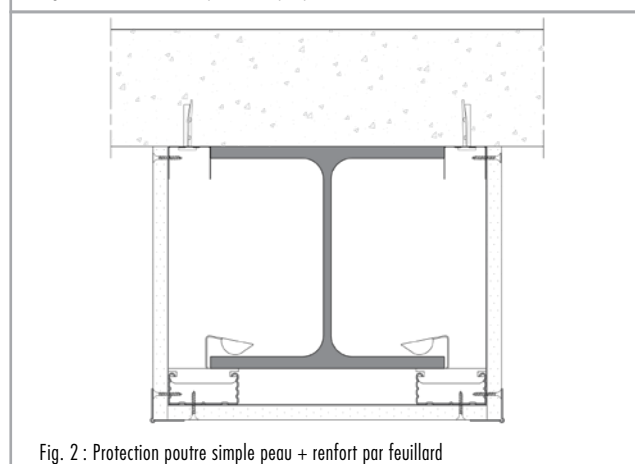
Protection poutre simple peau + renfort par feuilard
